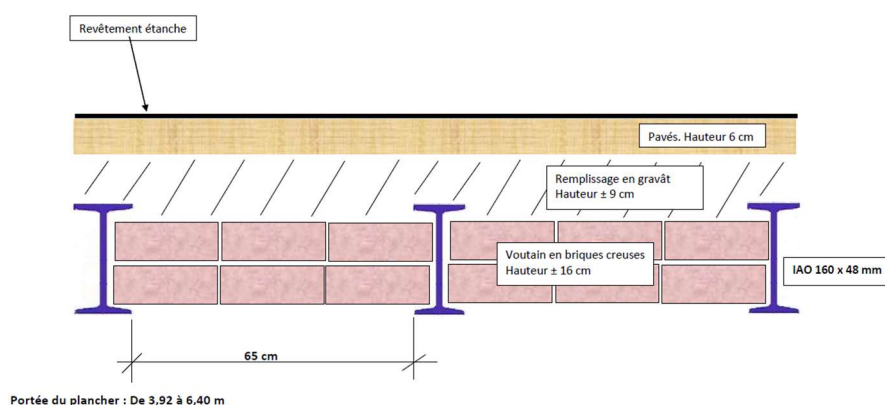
Relevé du plancher bas de la cour au sondage SD1. Rapport Rincenc BTP
